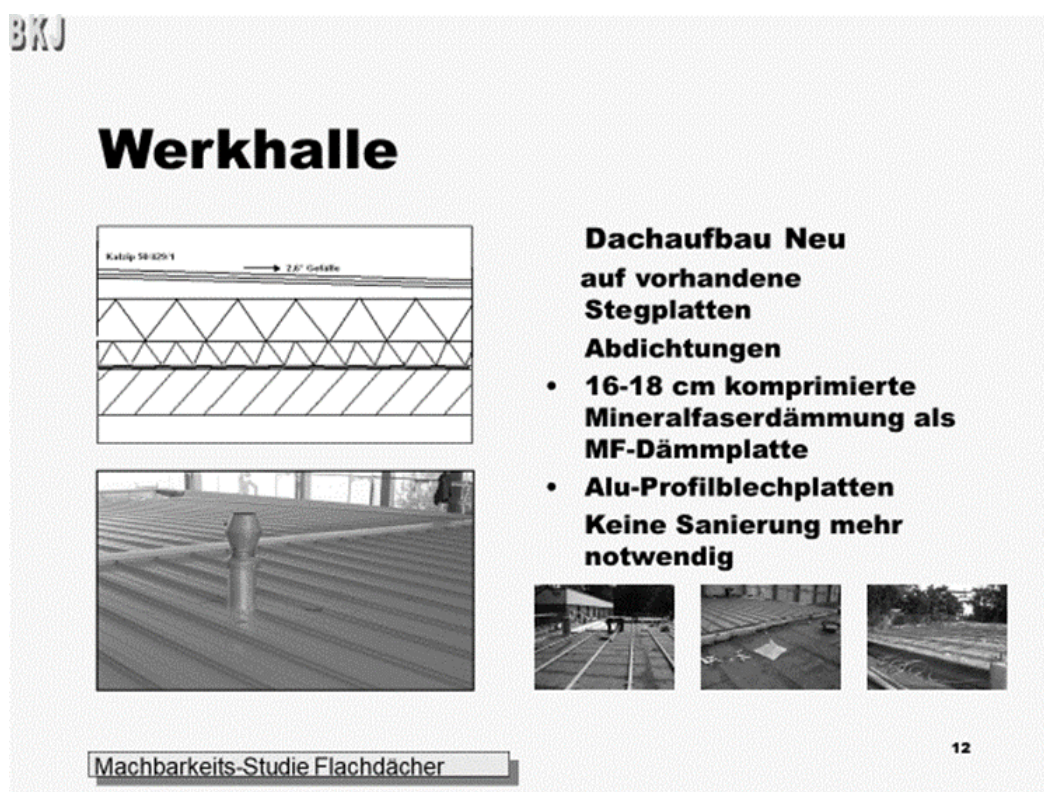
Dach Werkhalle nach Sanierung (lt. Kunden-Bericht)
